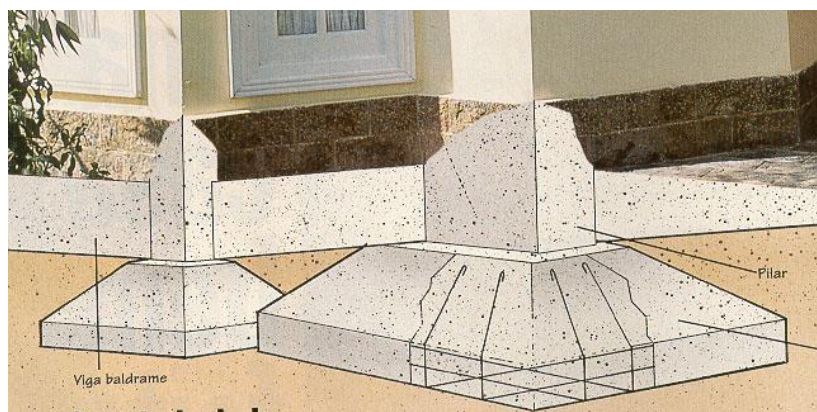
Ilustração de sapata isolada em uma construção de pequeno porte.
